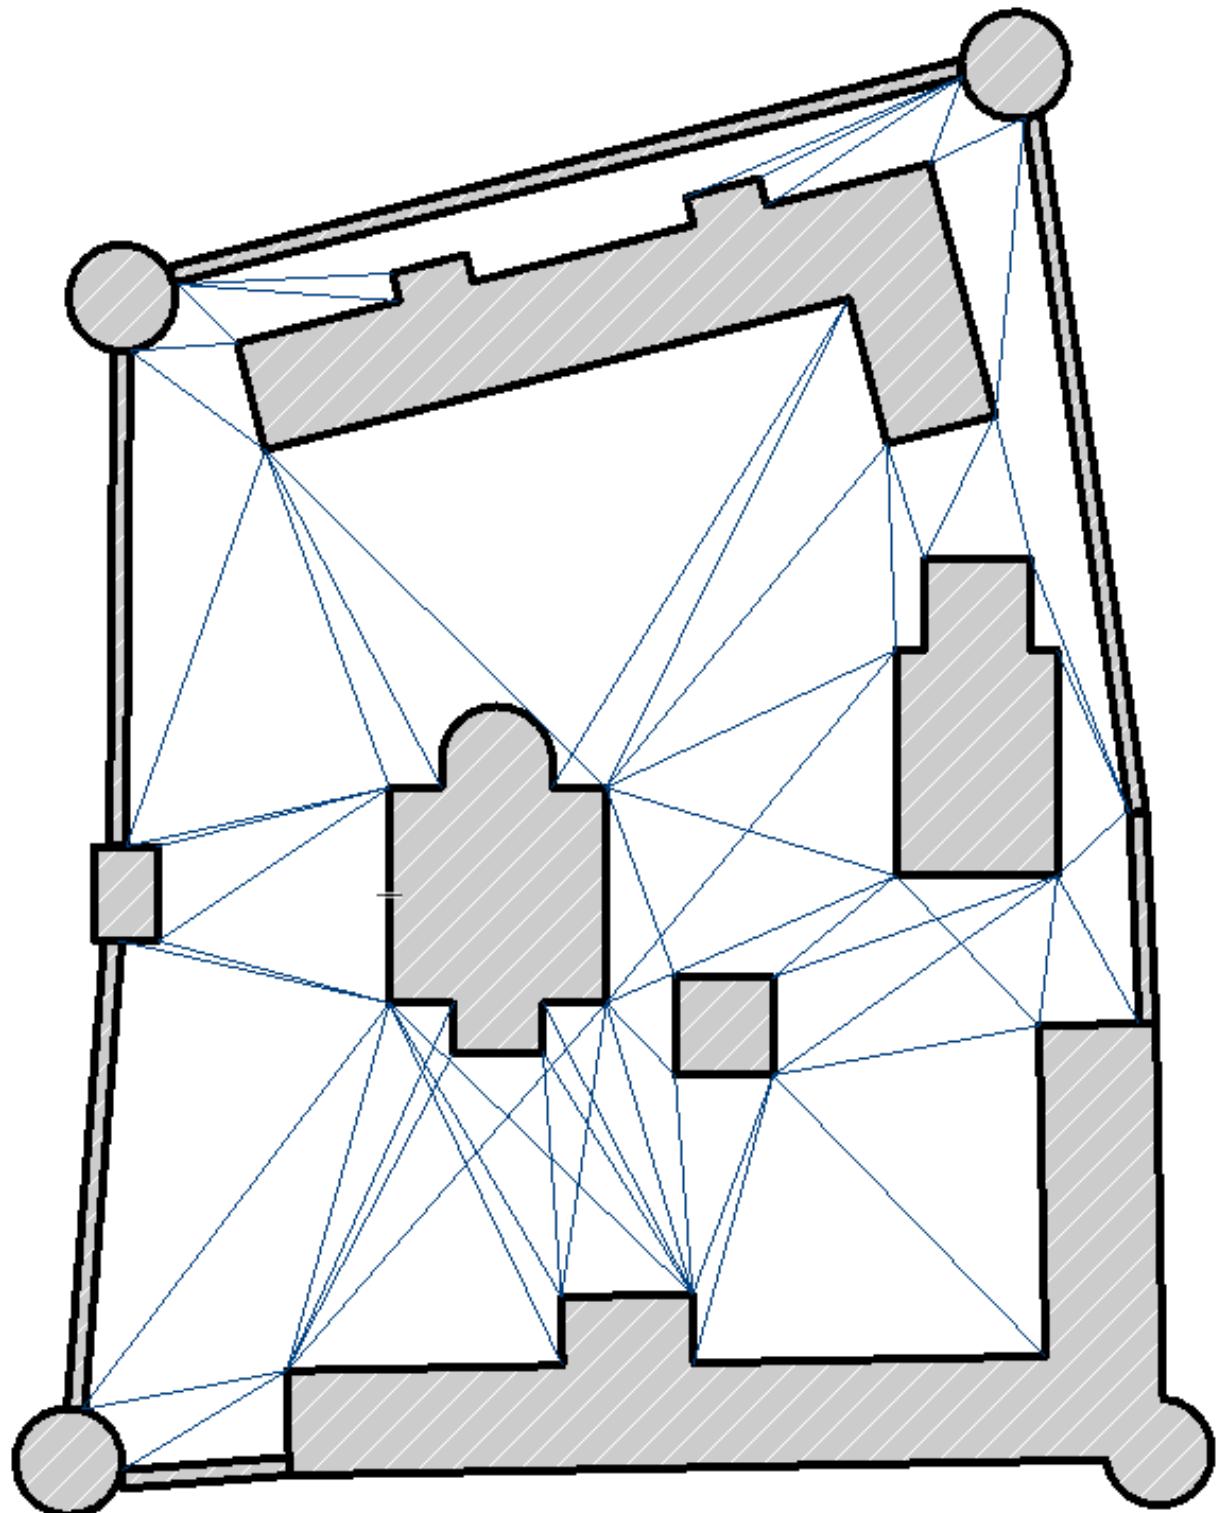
Обмеры генерального плана комплекса зданий засечками
